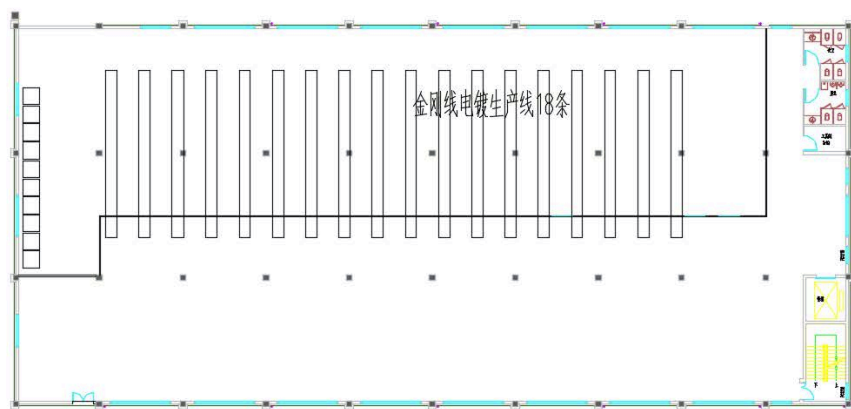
三号楼 2 层/3 层车间平面布置图
